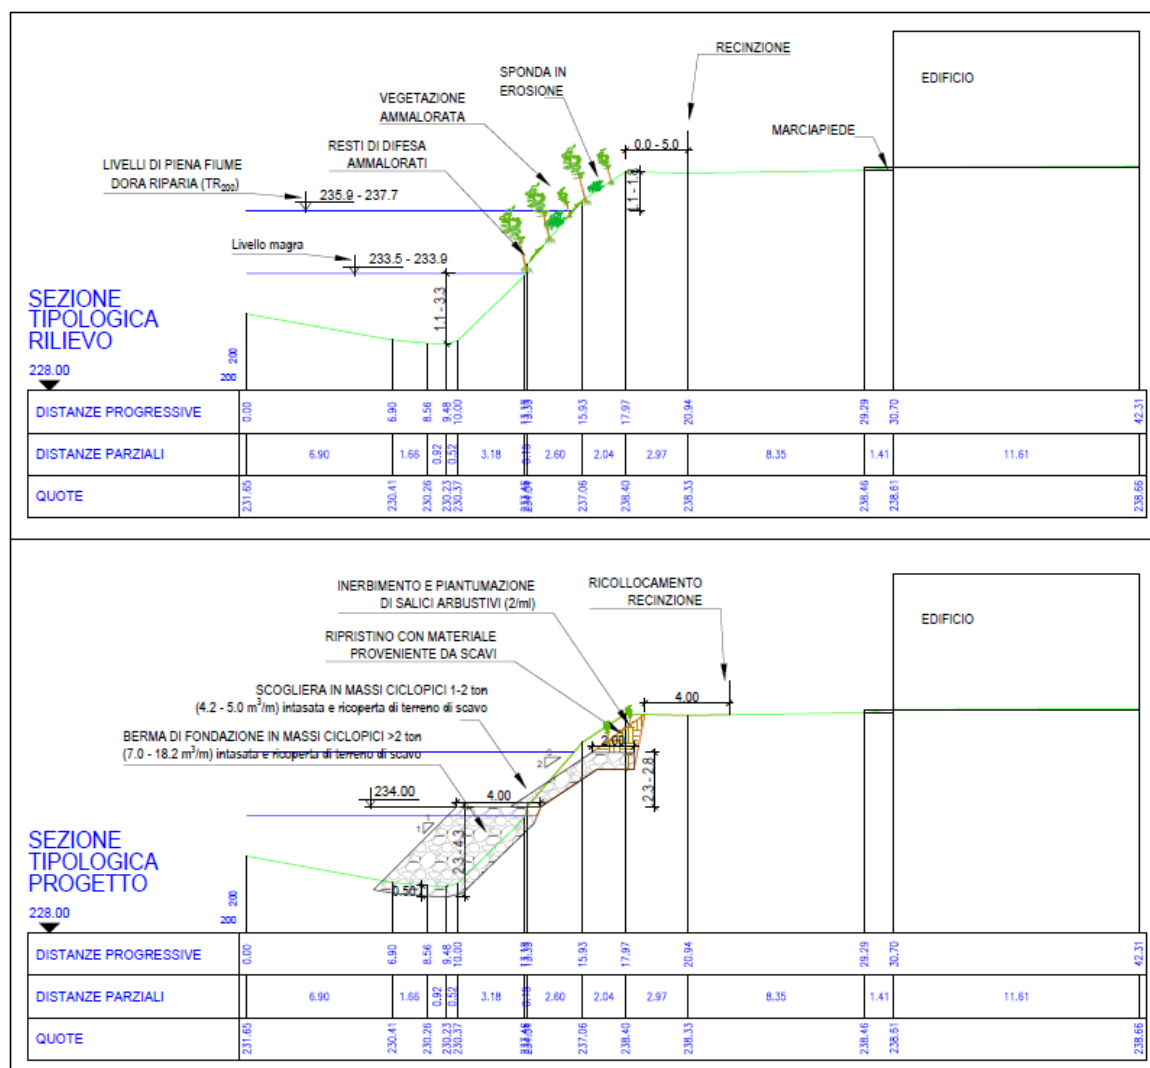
Estratto della Tavola D05 – Sezioni tipologiche.
